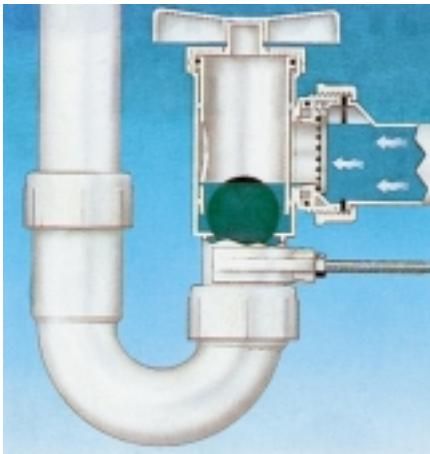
Rückstau-Geruchverschluss mit automatisch schließender Rückstauklappe, Kugelschloss und Handverschluss
